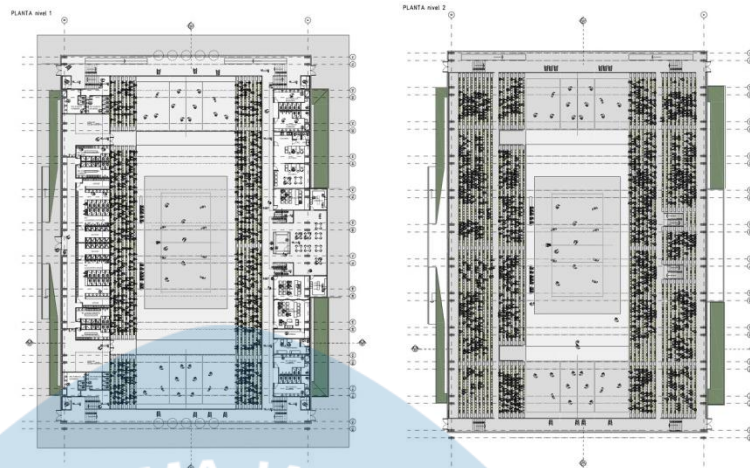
Denah Lantai 1 dan 2 Guillermo Gaviria Correa Coliseum
